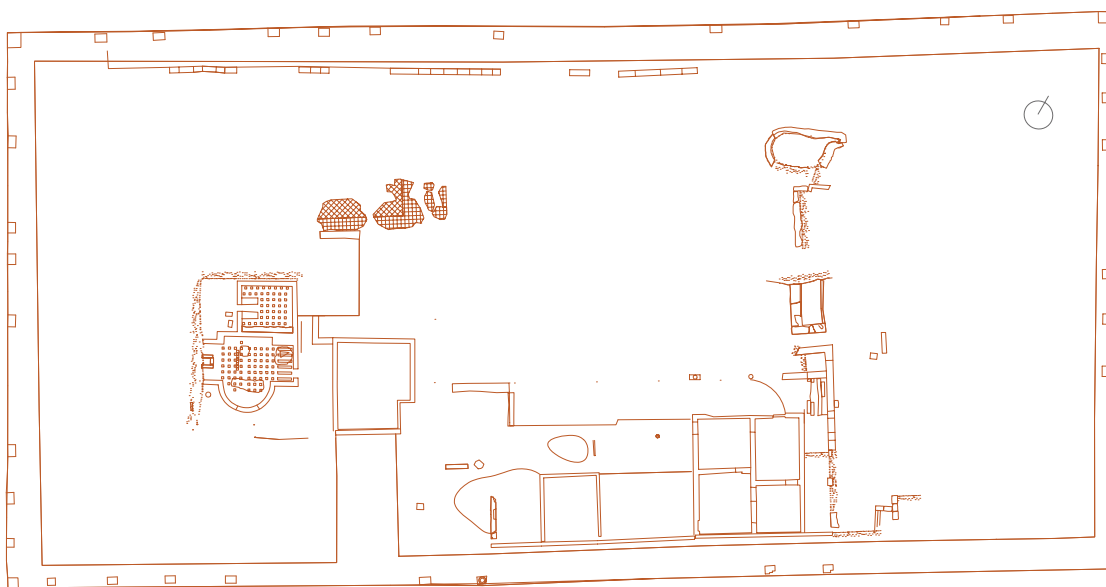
Plano del estado actual del Edificio de Neptuno (fuente: R. Angulo, 2009. *Elaboración de las fichas diagnóstico de los bienes inmuebles del CAI*)
